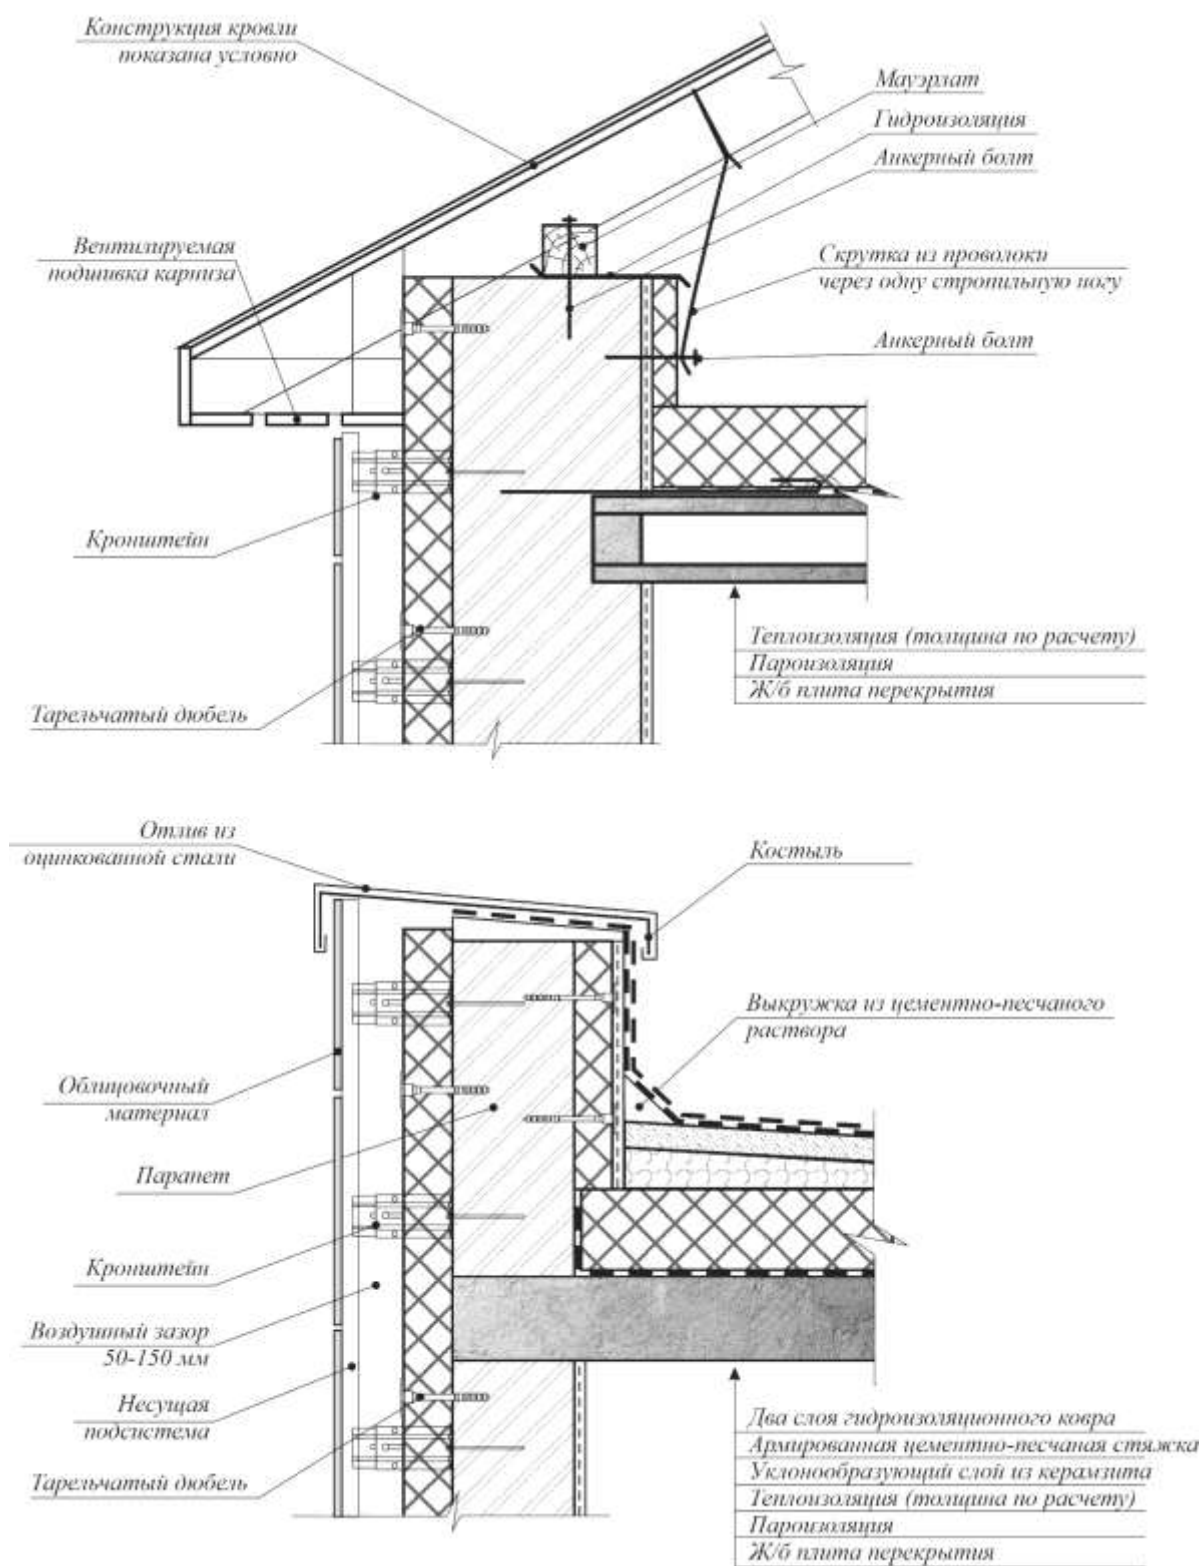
Узлы примыкания наружной стены с системой навесного фасада к скатной и плоской кровле
